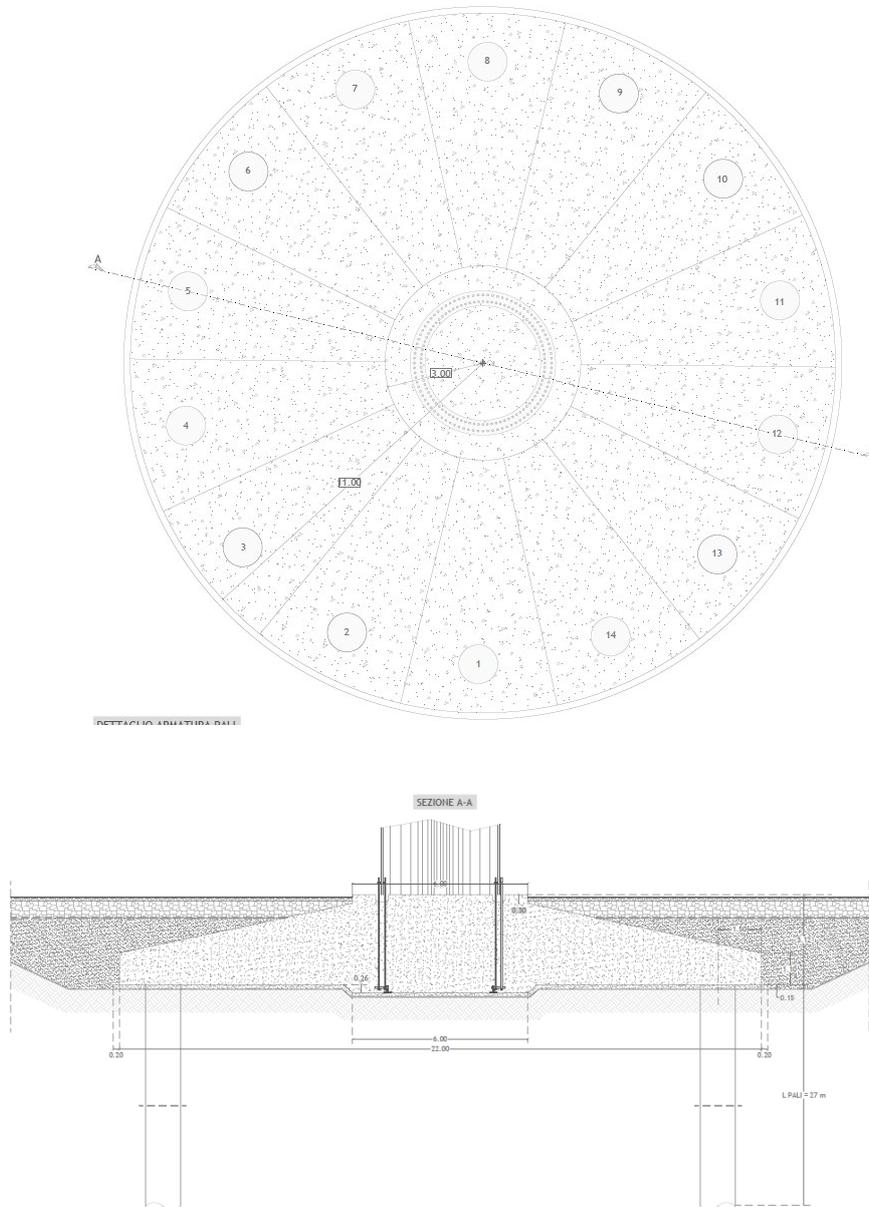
Pianta e sezione della fondazione (plinto su pali) del Progetto d'ammodernamento
